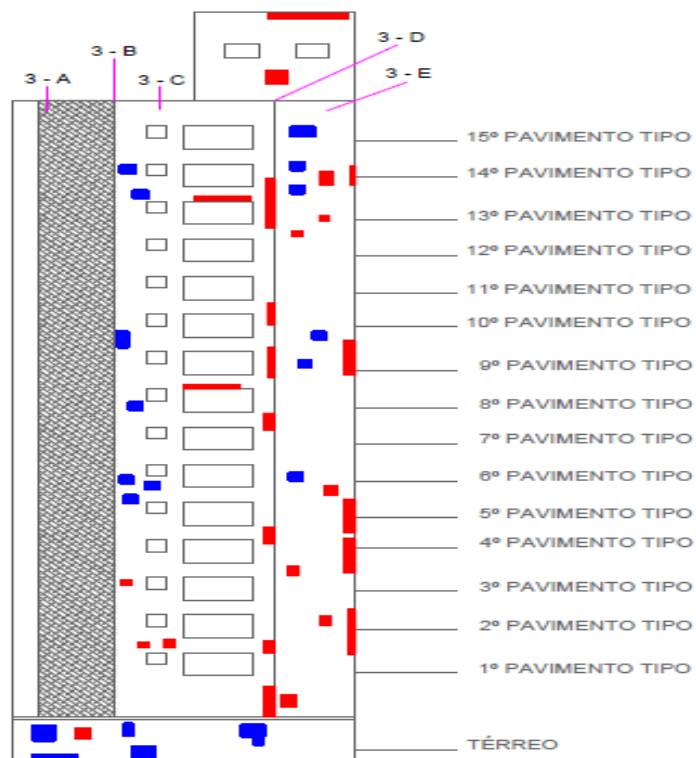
Mapeamento da fachada 2 (fachada frontal).
